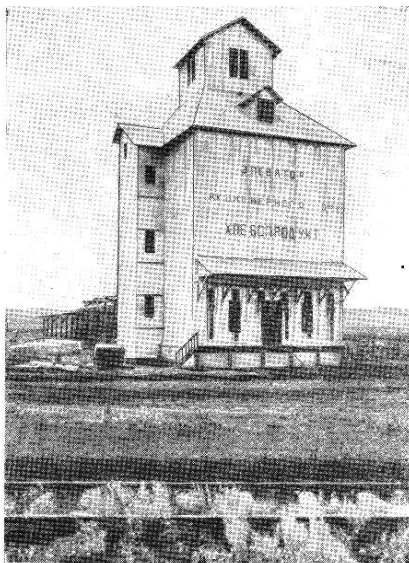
Зернозаготівельний елеватор типу 1924 р.
